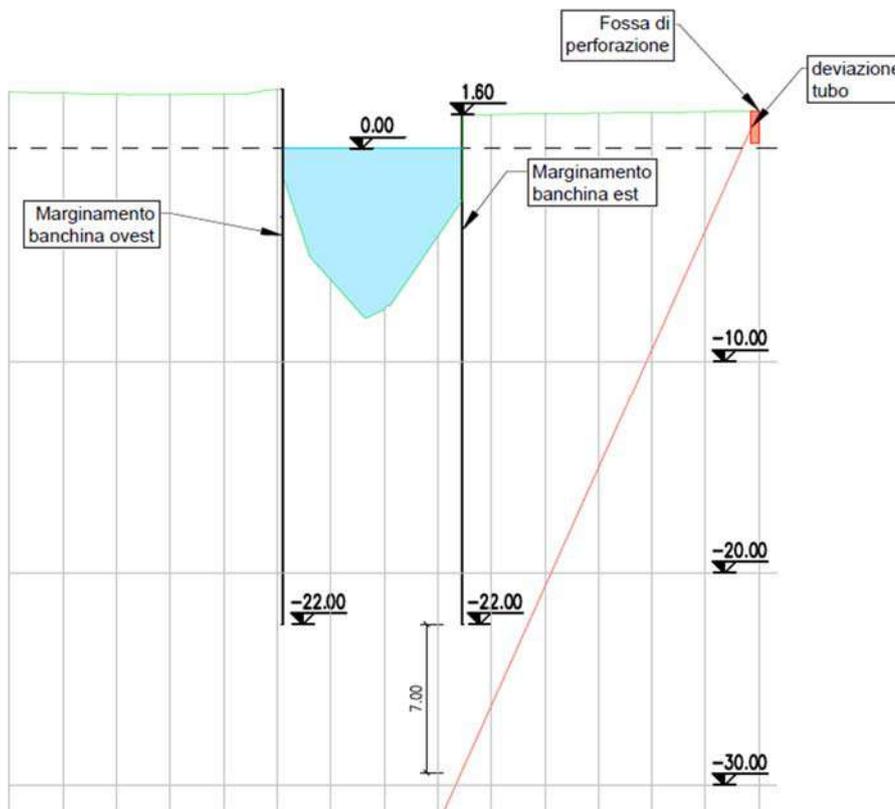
Sezione - dettaglio ingresso Est su via Righi
